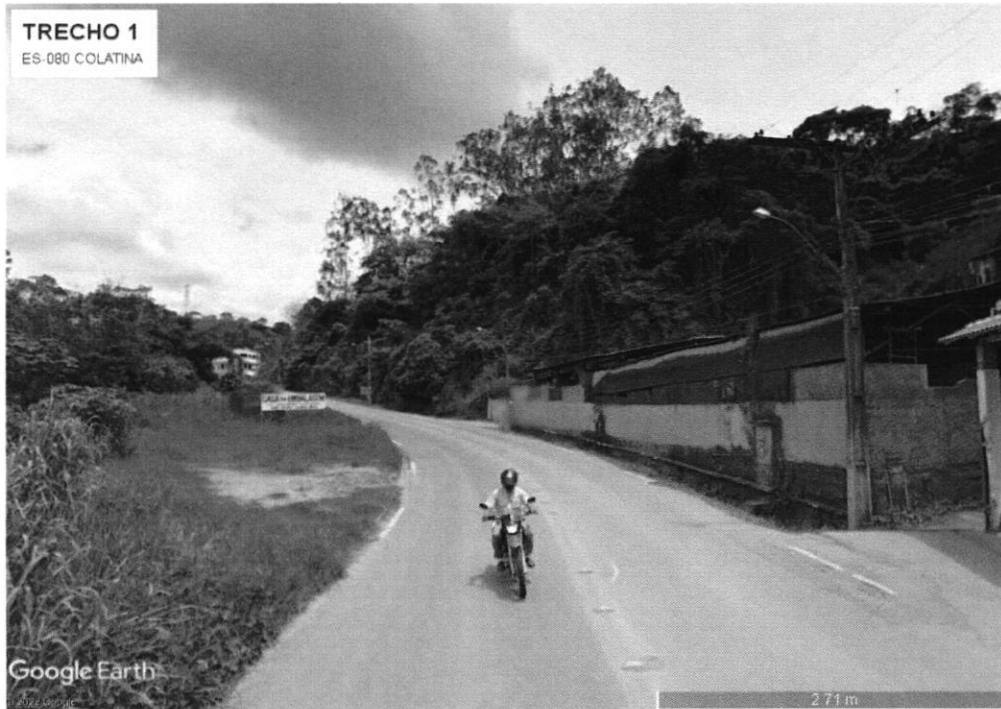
FOTO MOSTRANDO CONSTRUÇÕES E ILUMINAÇÃO PÚBLICA
